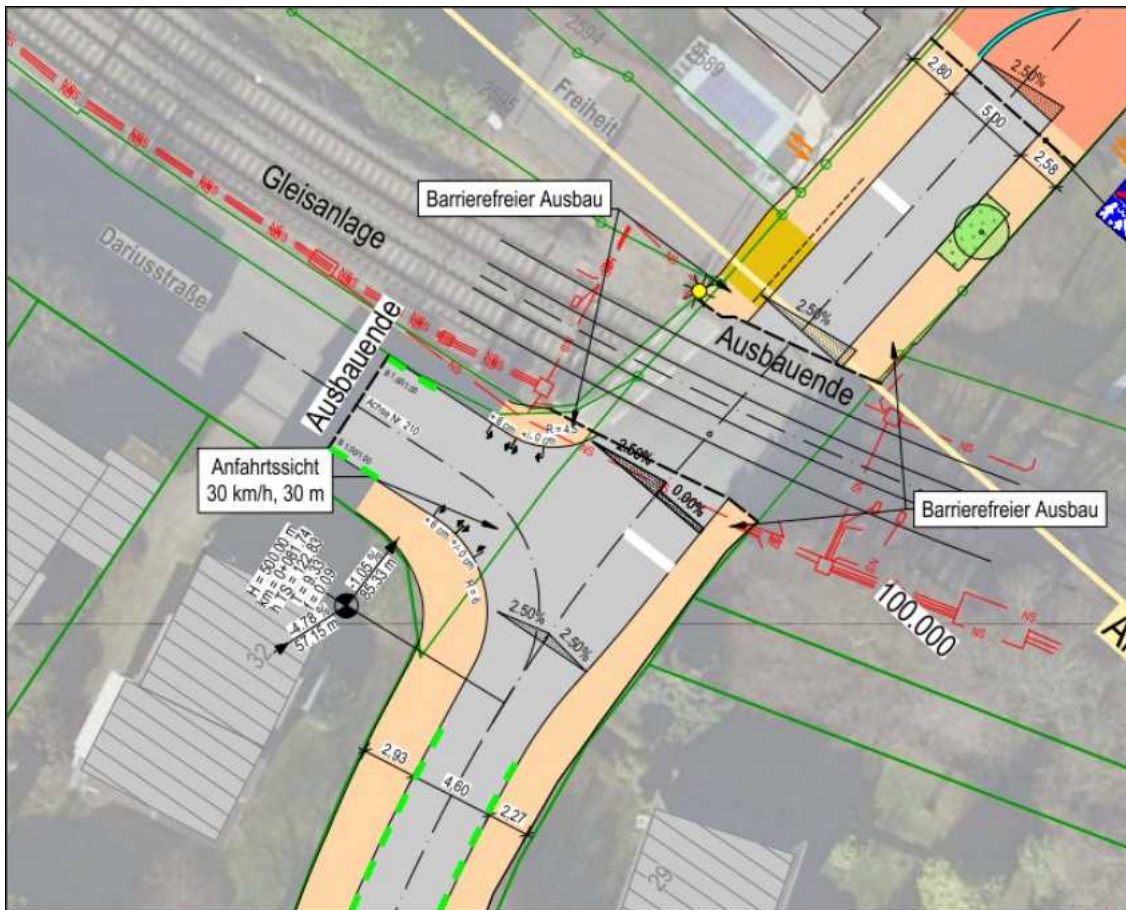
Auszug Lageplan 1 Variante 3.1.1 Ferdinand-Stucker-Straße (Stadt Bergisch Gladbach 2026)
